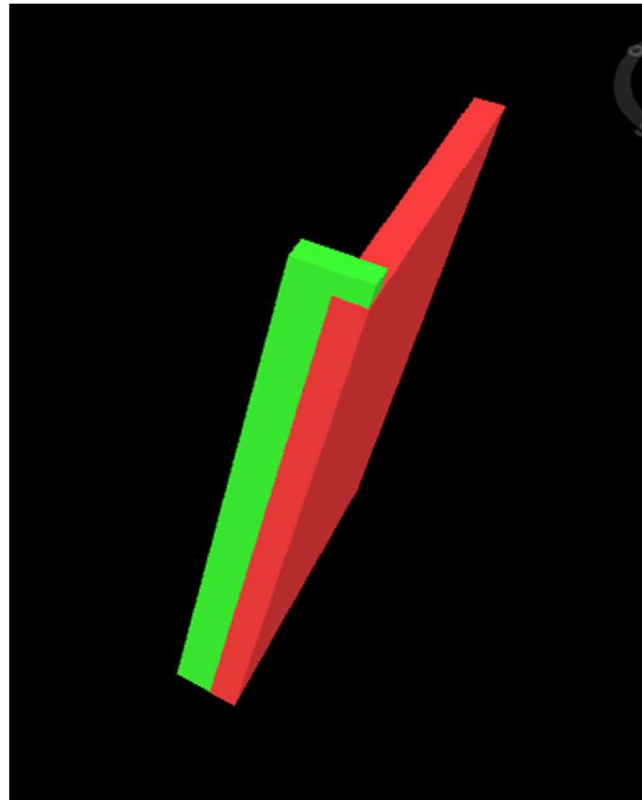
Conflito, caixa de inspeção e viga baldrame
